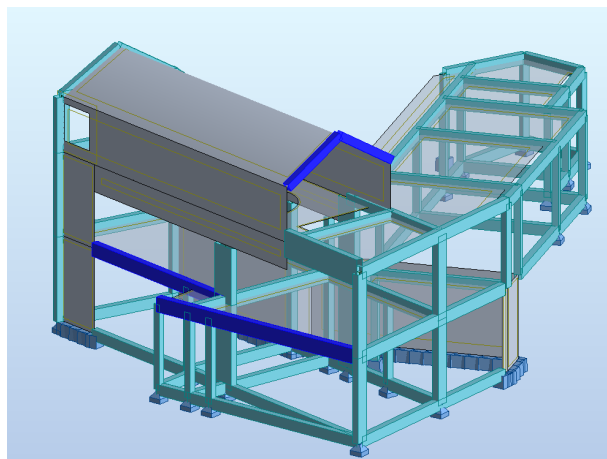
Vigas selecionadas para dimensionamento e pormenorização de armaduras.
